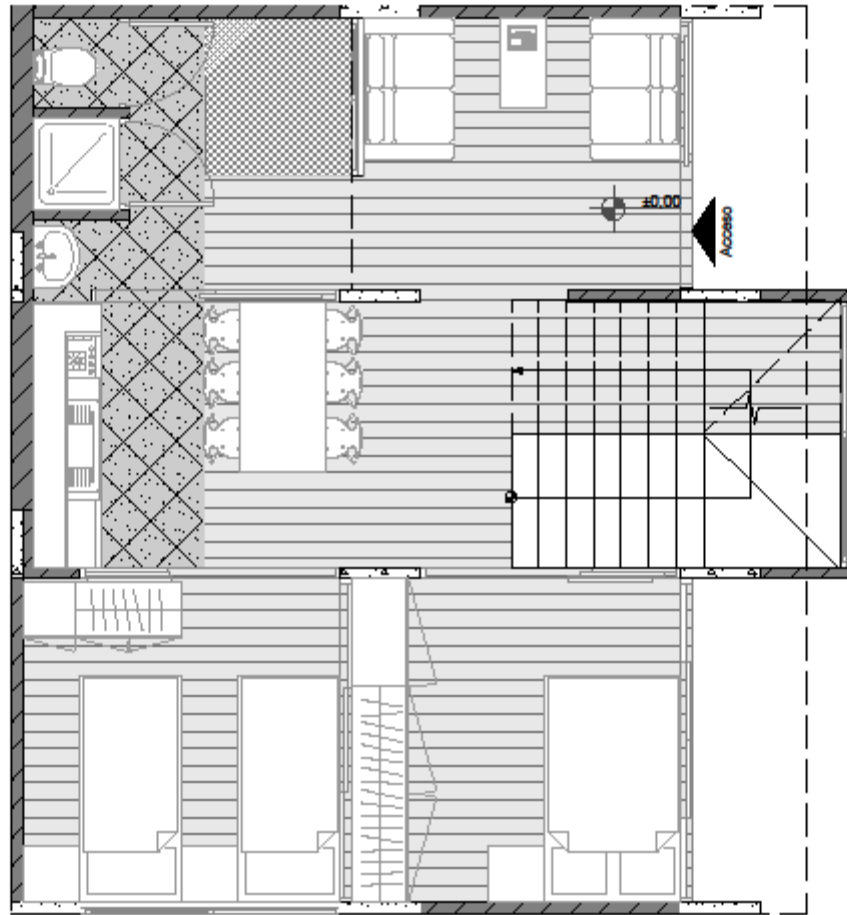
Tipo B. Plano de Amoblamiento Primer Piso. Esc.: 1:50
